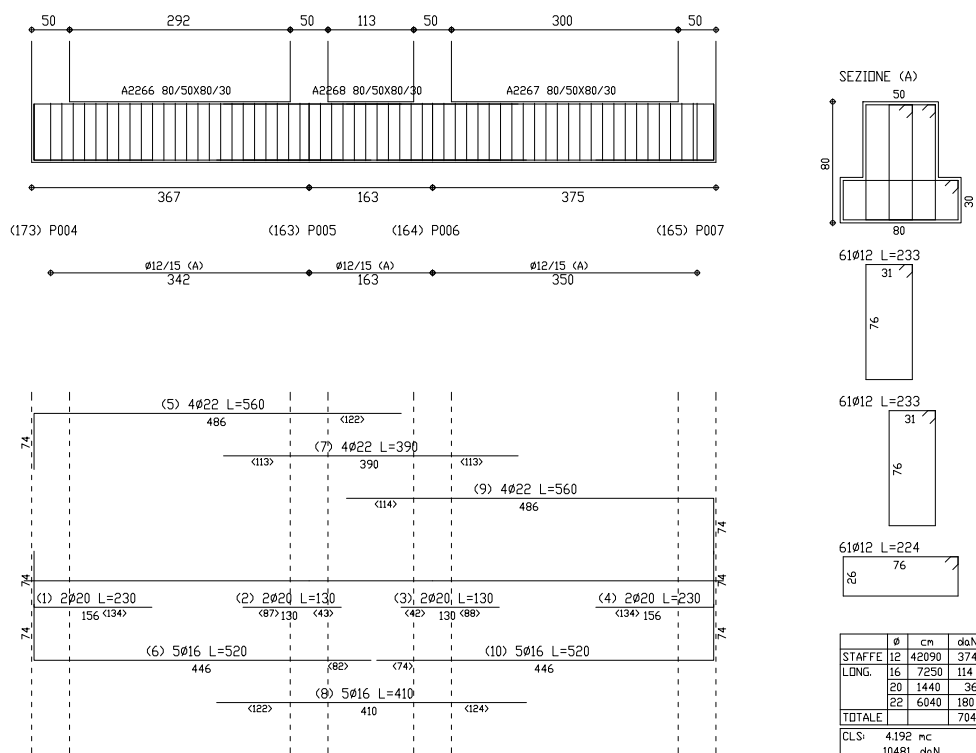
Carpenteria travi di fondazione-Edificio a telaio
